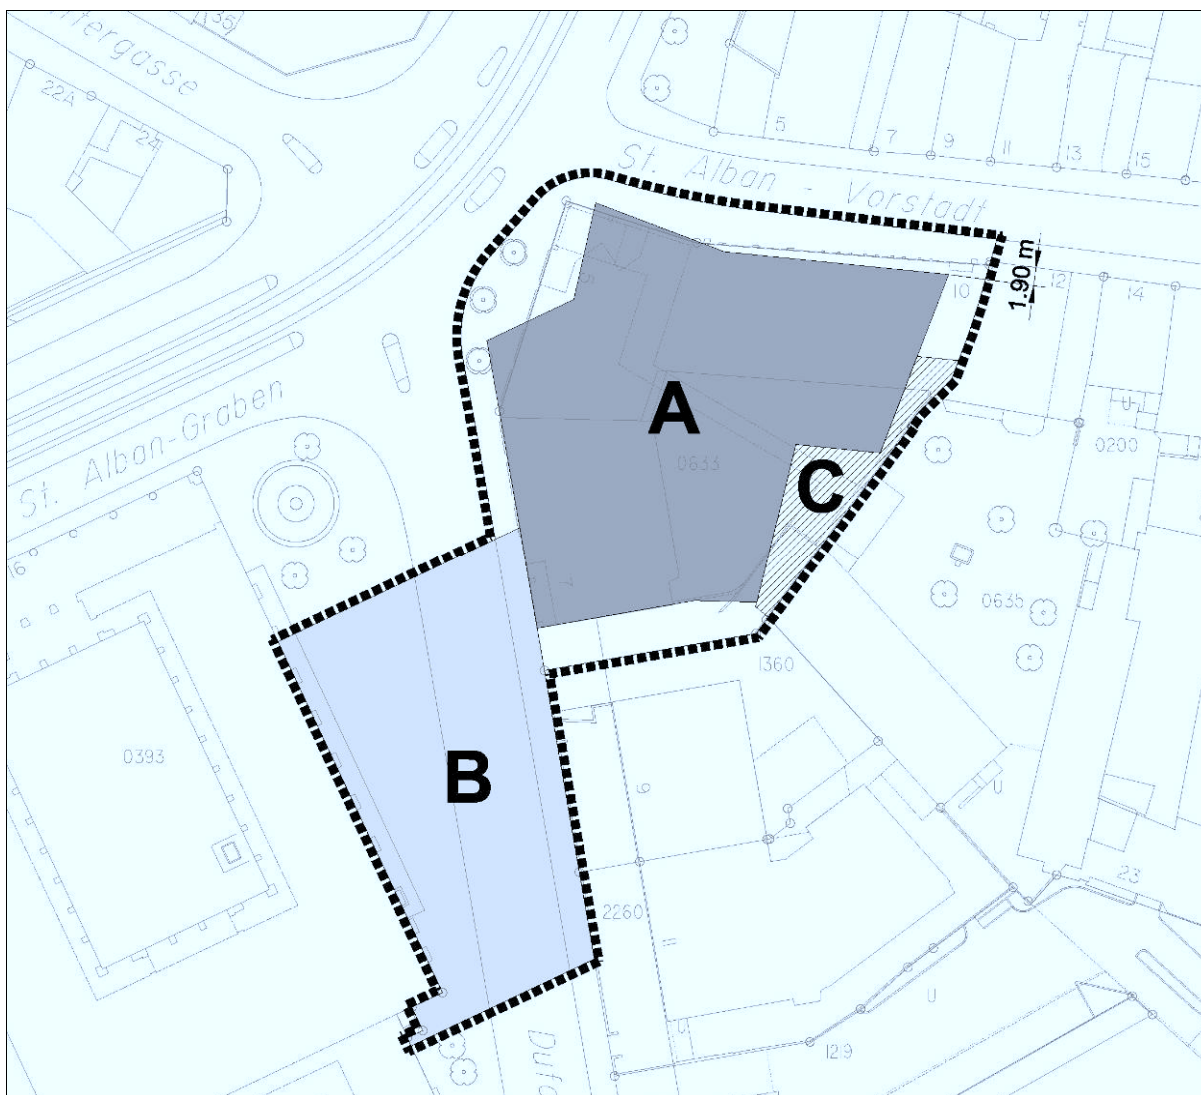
Bebauungsplan Erweiterung Kunstmuseum, Plan Nr. 13'488. (Kein Massstab, Plan genordet)
